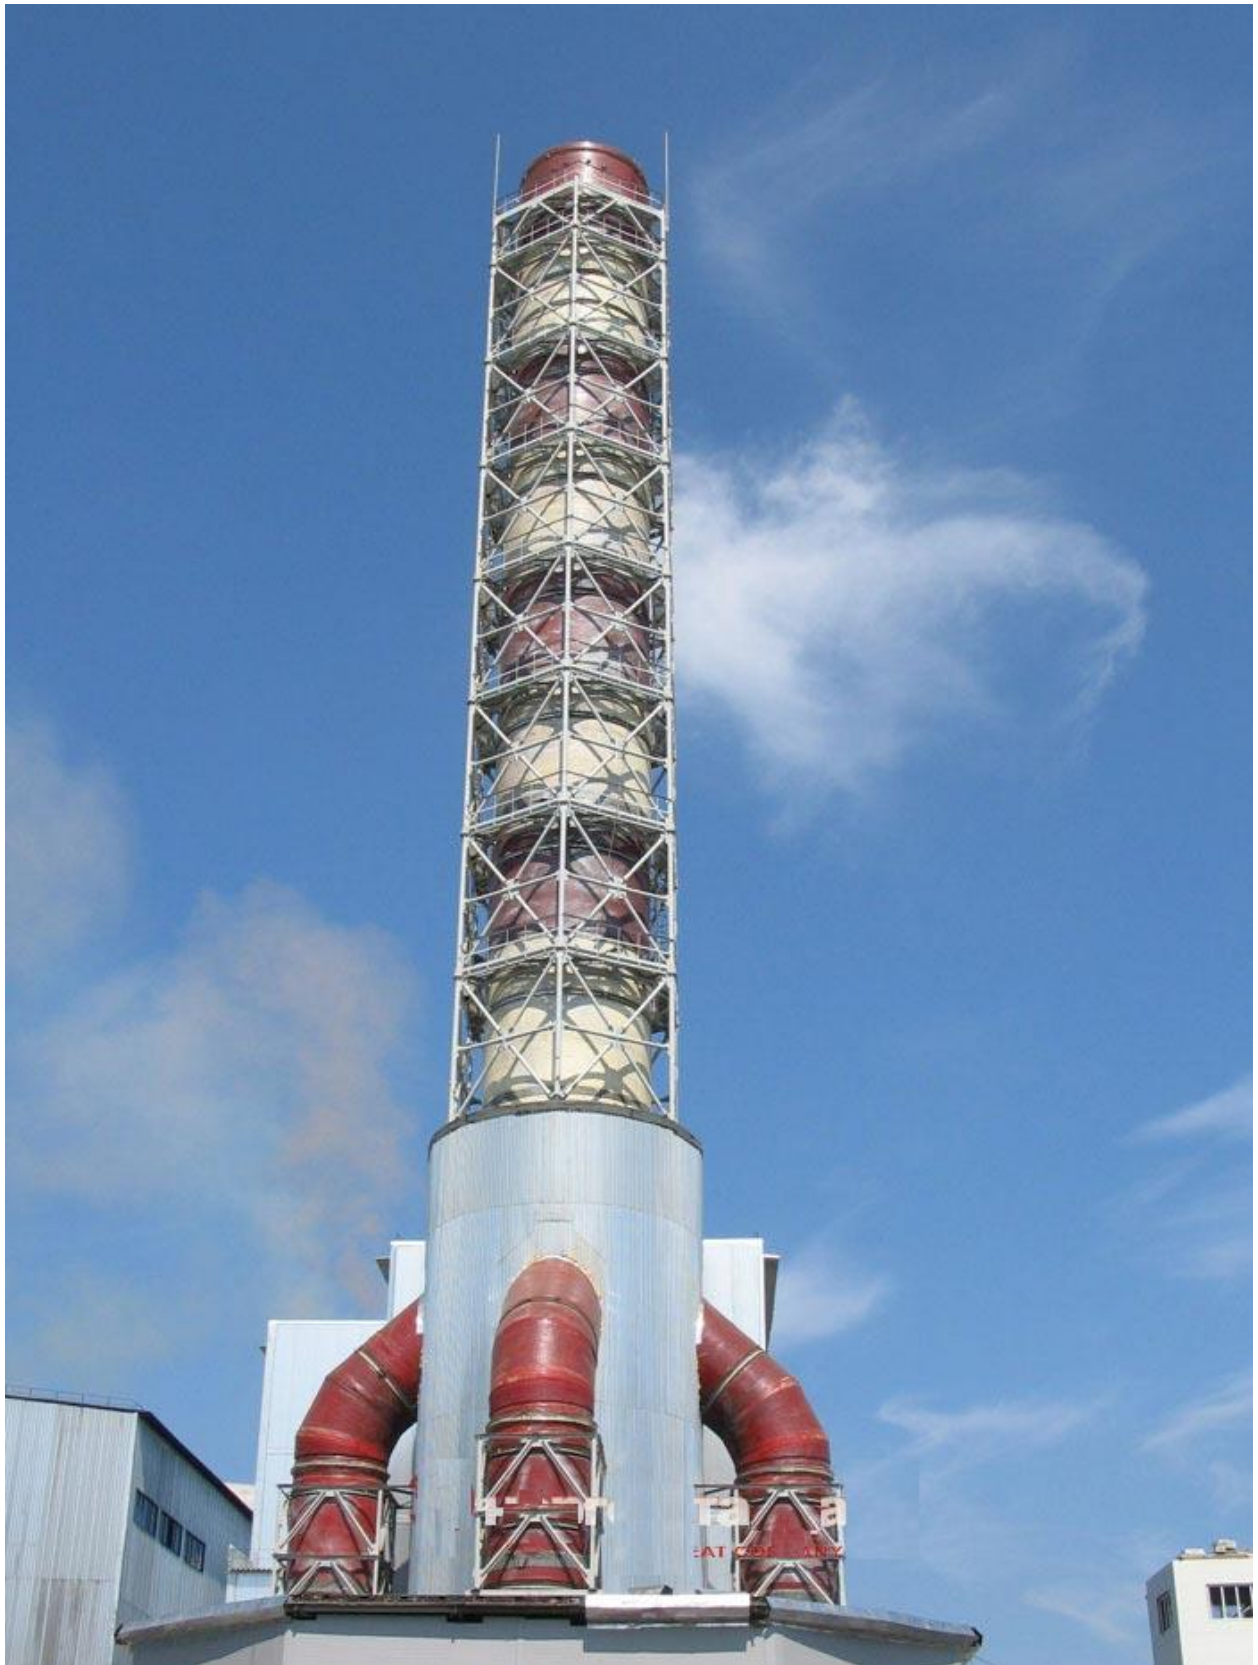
Вытяжная труба металлическая, общий вид
